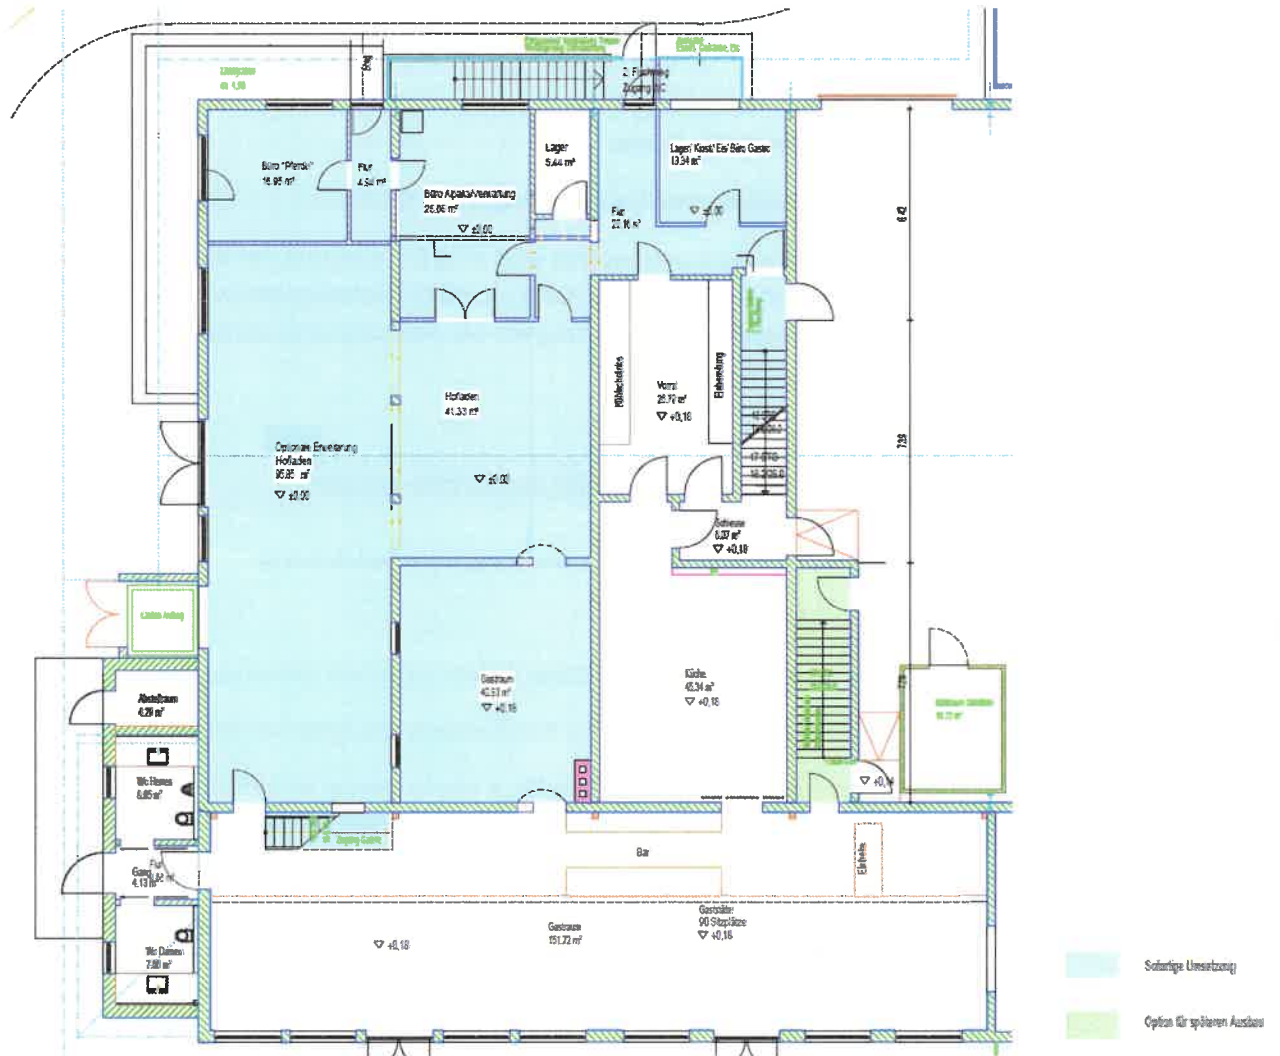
Grundriss EG – Gastwirtschaft mit Küche, Hofladen, Essensausgabe und Büros
